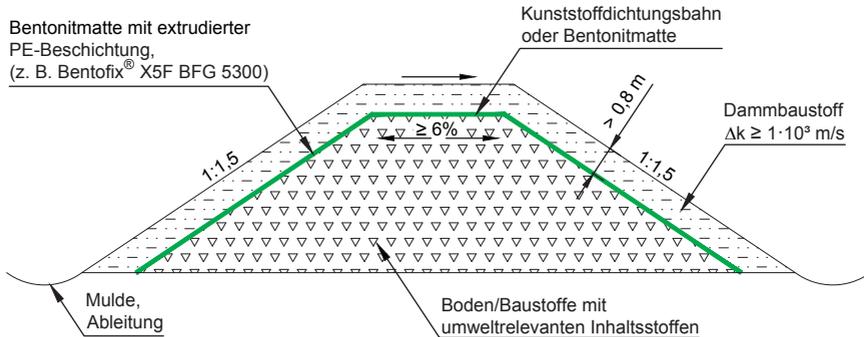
Ausführungsvorschlag für einen Wall in Bauweise A mit Geokunststoffen, Dammbauweise mit witterungsempfindlichen Abdichtungsbauteilen ohne Sickerschicht
